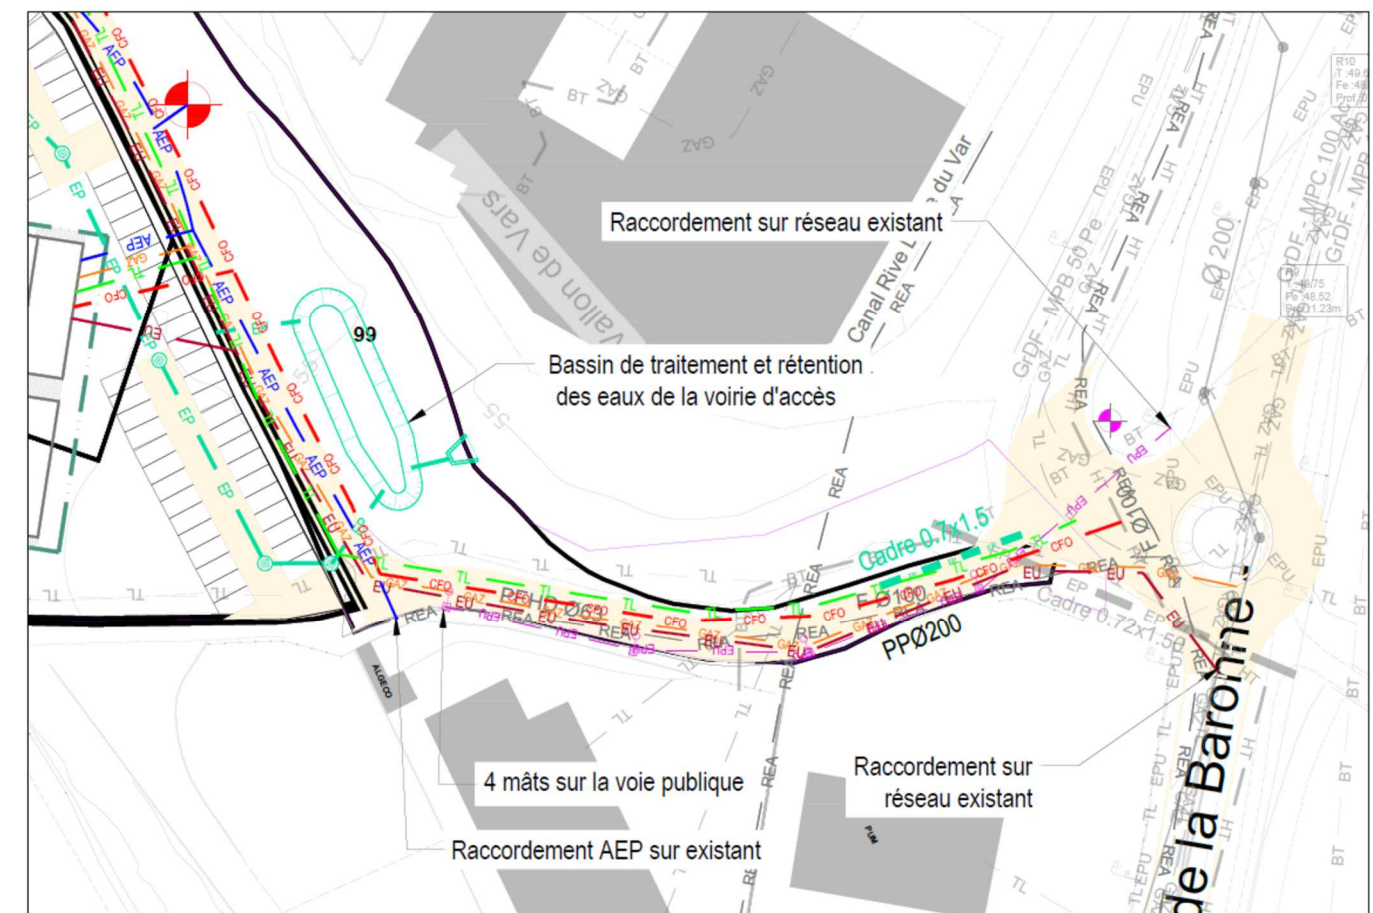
Plan prévisionnel des réseaux - zoom raccordement route de la Baronne
